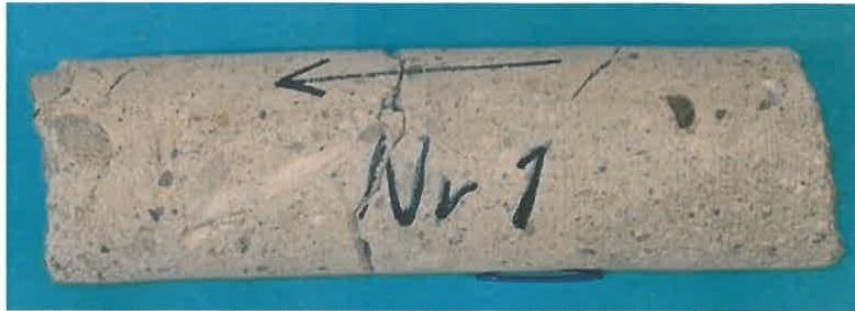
Oversiktsfoto av borkjerne Nr 1. Overflaten til venstre på bildet. Merk overflateparallell opprissing i betongen (delaminering).
